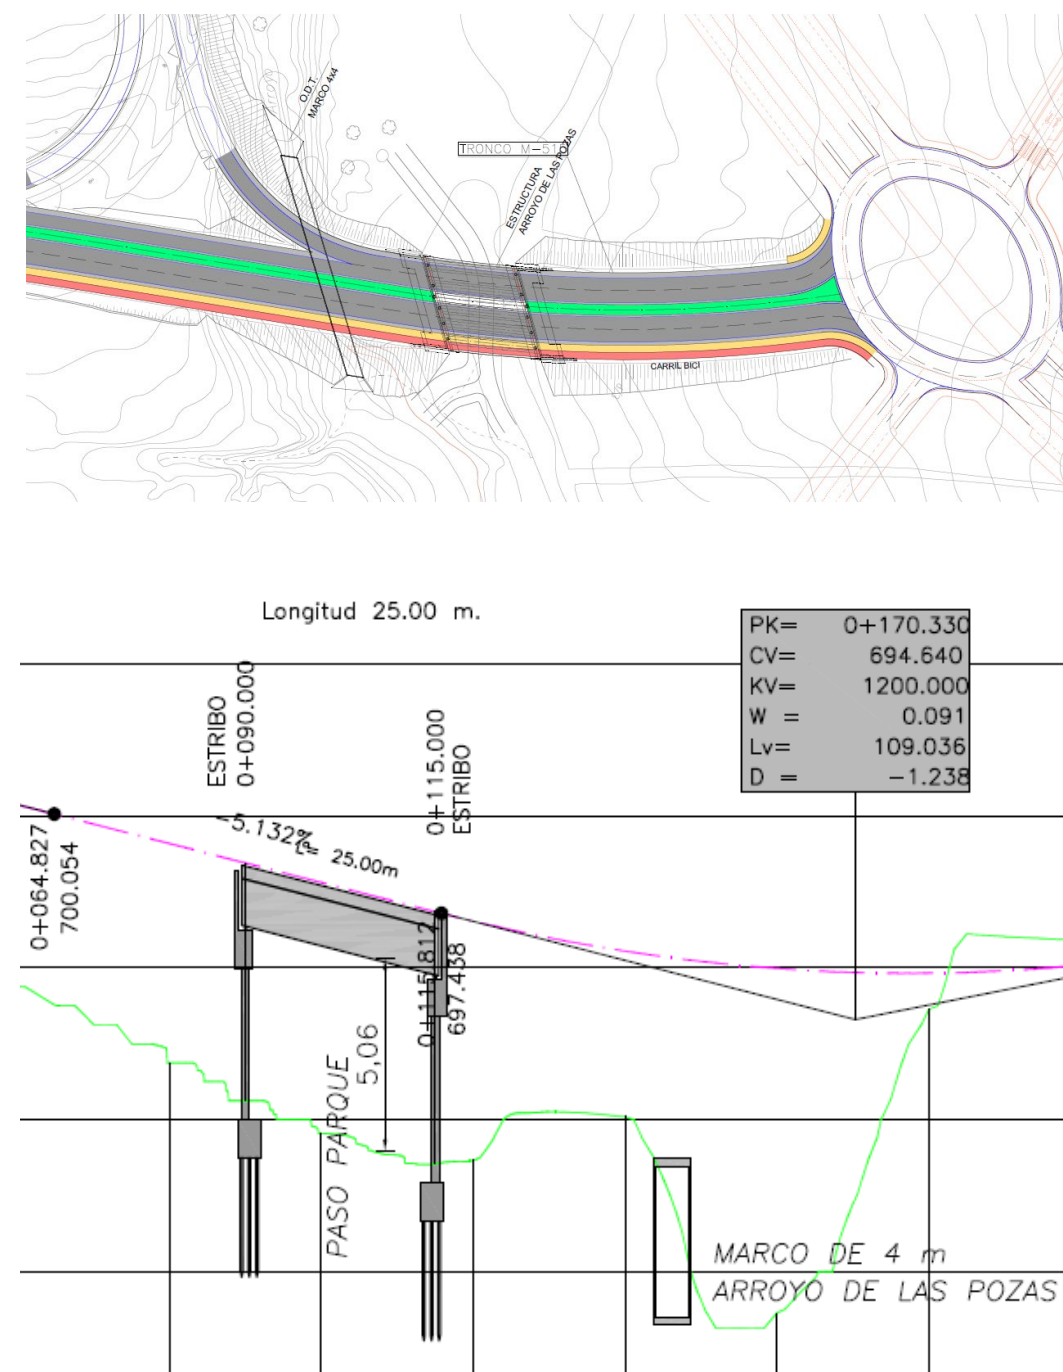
Perfil longitudinal ESTRUCTURA 5
